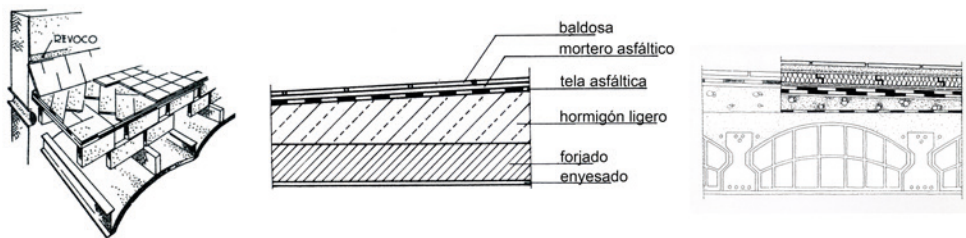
De izquierda a derecha: cubierta tradicional con cámara de aire ventilada, cubierta tipo sándwich con hormigón ligero para formar pendientes y aislar térmicamente, y cubierta invertida con las placas de aislamiento por encima de la lámina de estanqueidad, en sustitución de la solución anterior.
